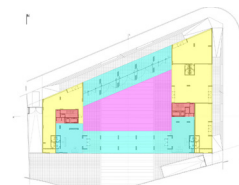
Planta baja. Fuente: Archdaily, 2018.
